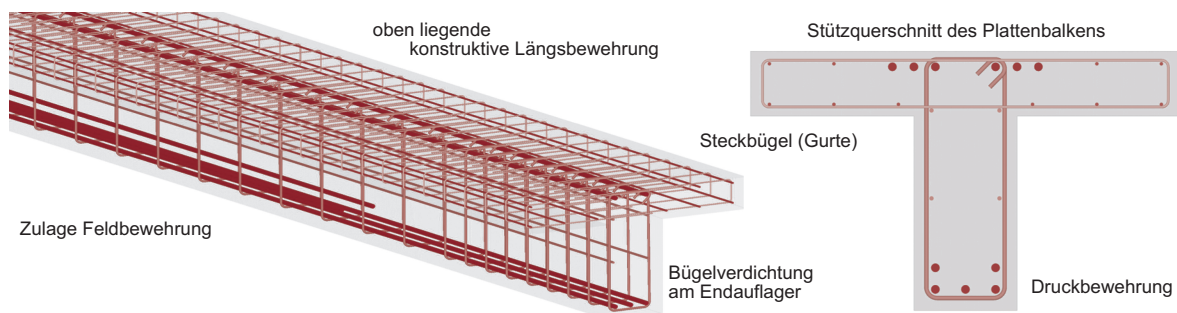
Bewehrungskonstruktion für den monolithisch hergestellten Plattenbalken
